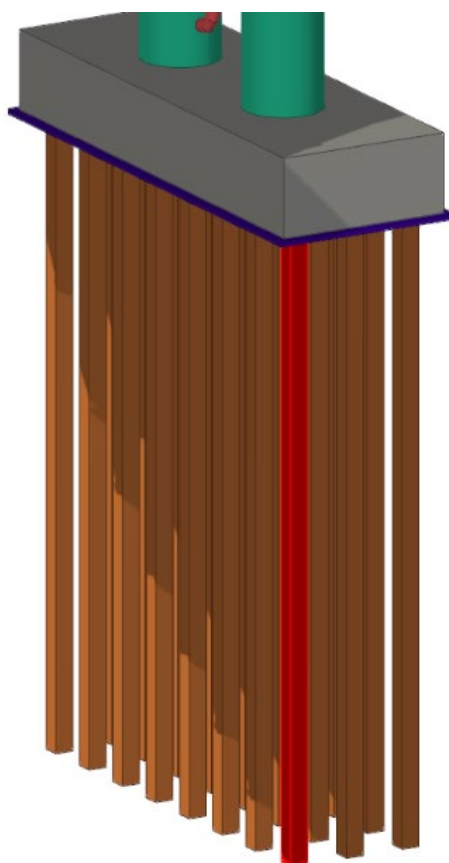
Элемент ЦИМ «железобетонная свая промежуточной опоры»
